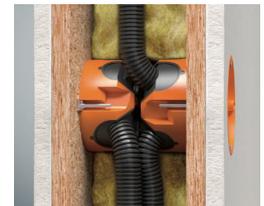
Luftdichte Hohlwandinstallation/Leitungs- und Rohreinführungen
